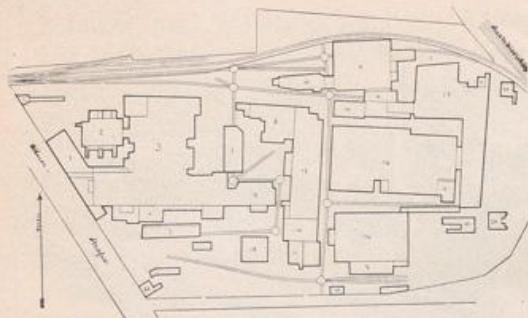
Düsseldorfer Röhren- und Eisenwalzwerk. Abteilung Oberbilk. Lageplan. 1:5300.
